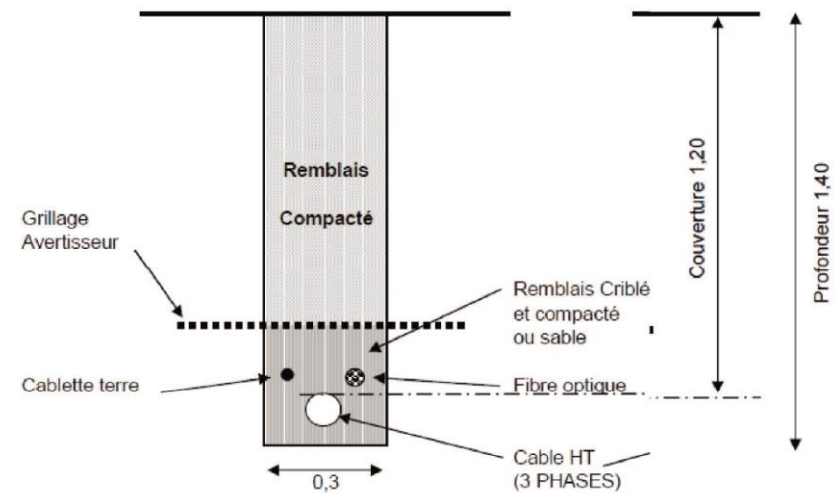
Coupe type d'une tranchée accueillant le câblage (Source : BE Jacquel et Chatillon)
